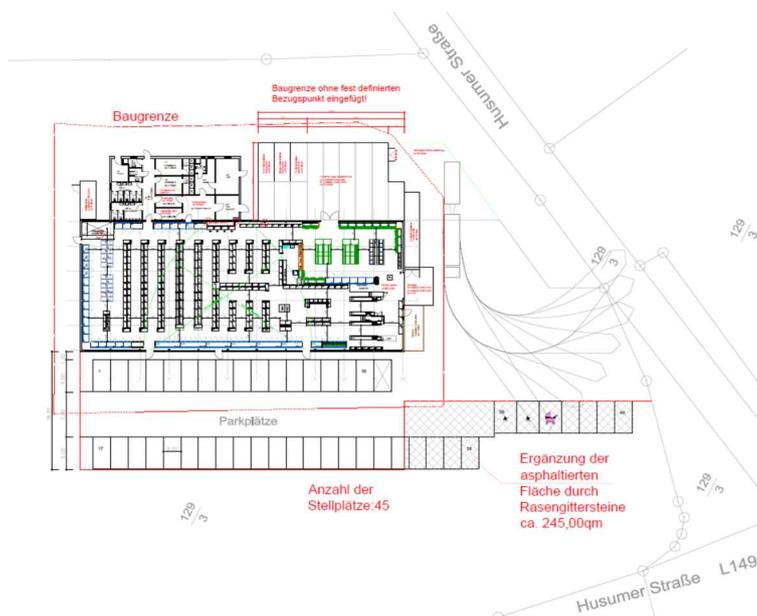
Lageplan - REWE Markt GmbH, 2024
